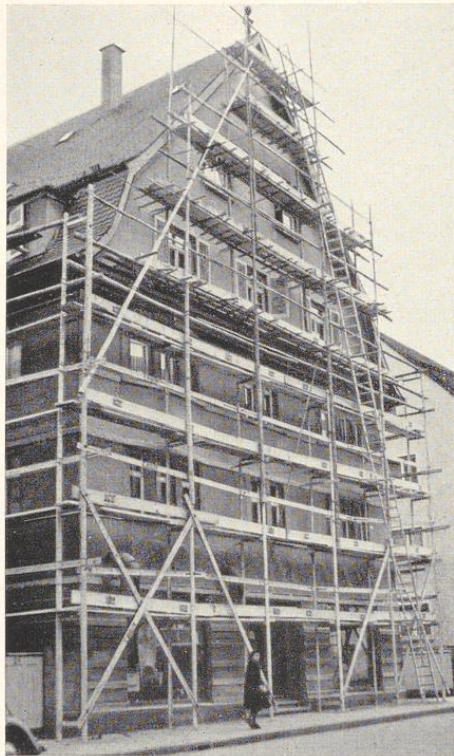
Einfaches Leitergerüst mit Doppelstangengerüst
